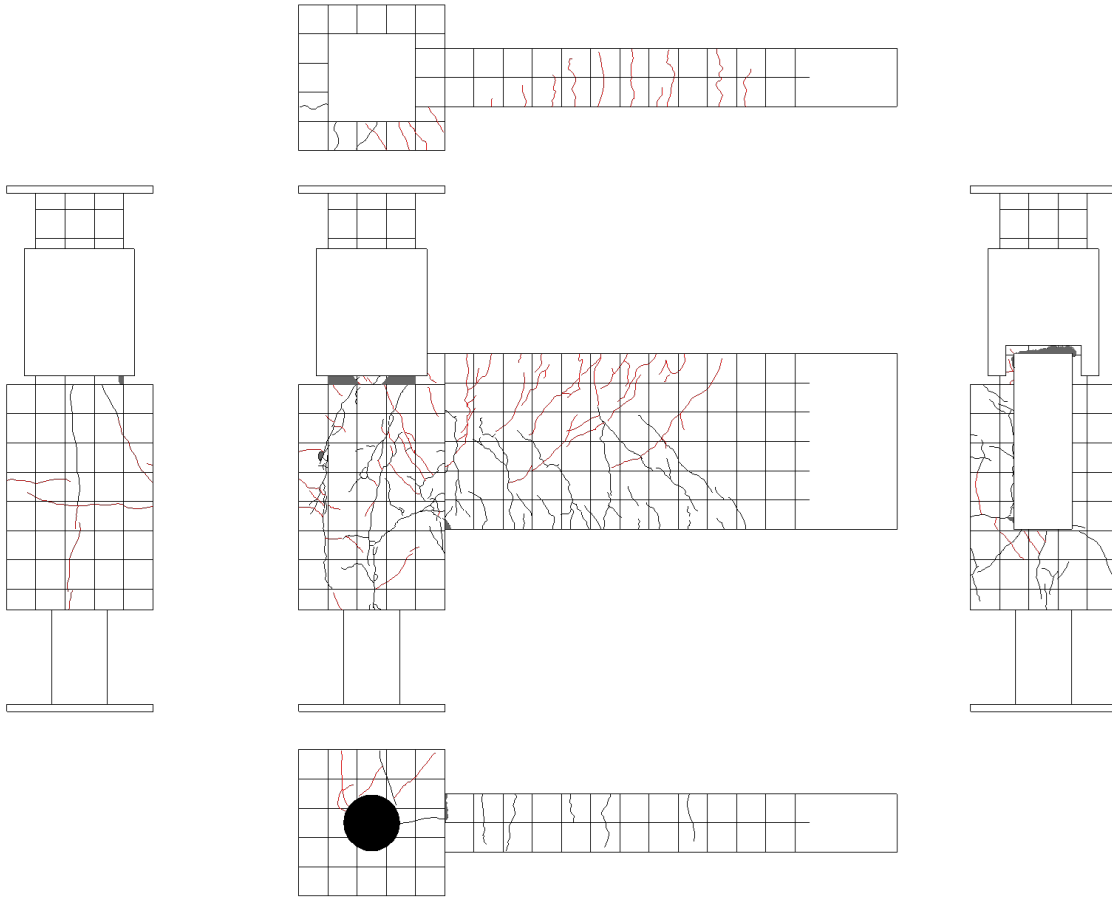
3. 61 試験体 A-2 ひび割れ状況 (8Cycle)
